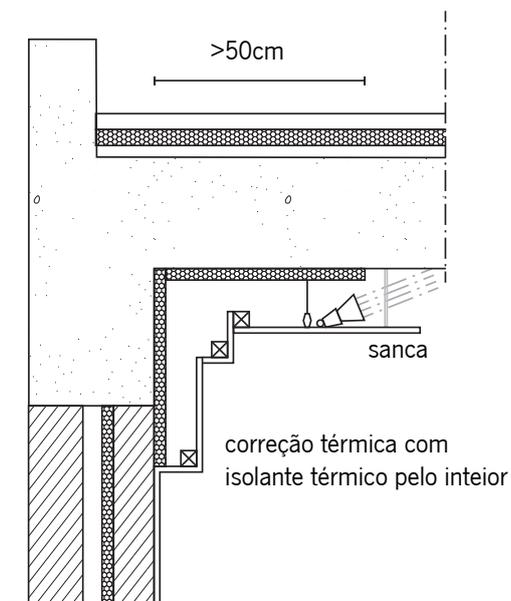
Pormenor de Correção em sanca com iluminação oculta na zona de ligação parede exterior e laje com isolamento térmico pontual
